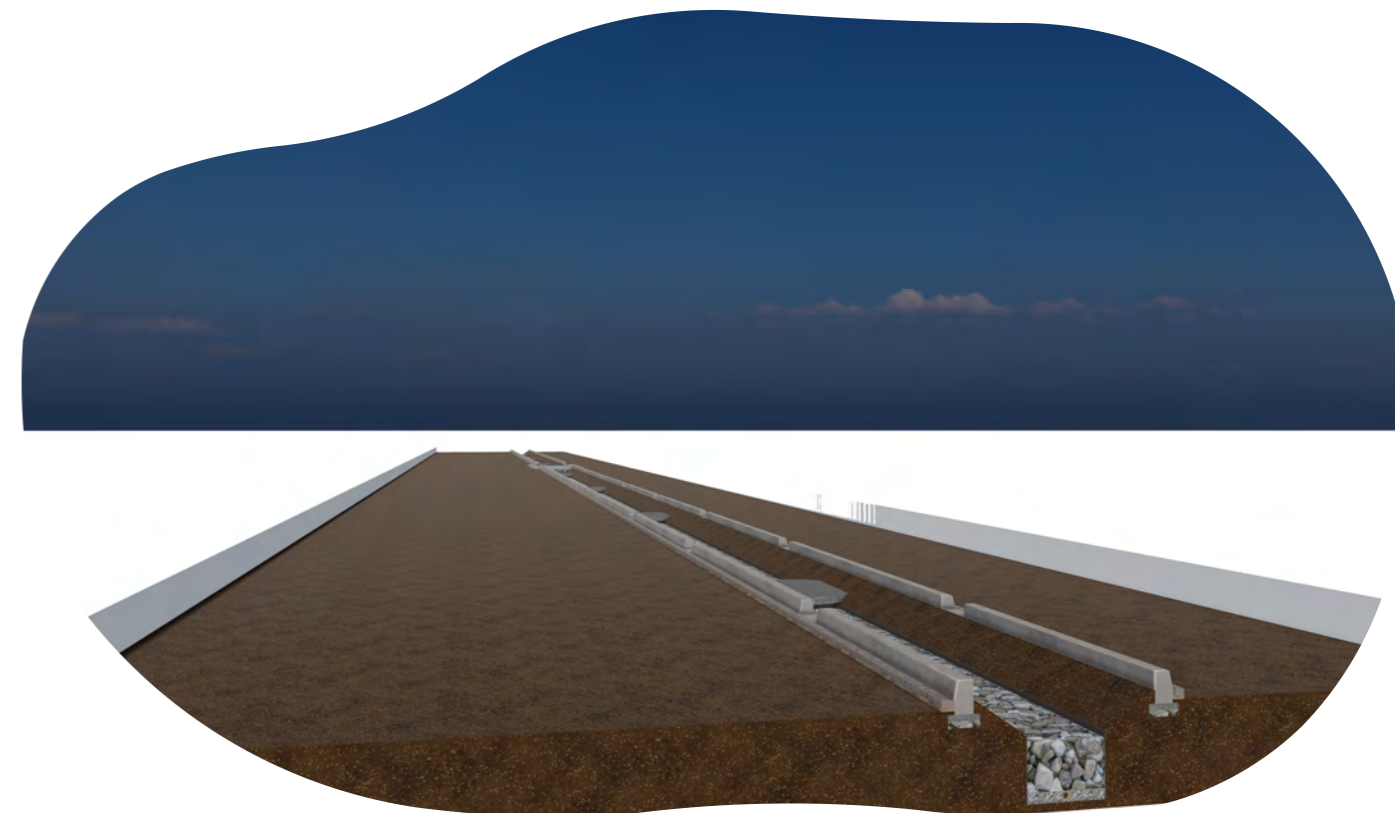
Execução da segunda camada de enrocamento e dos poços de infiltração.
